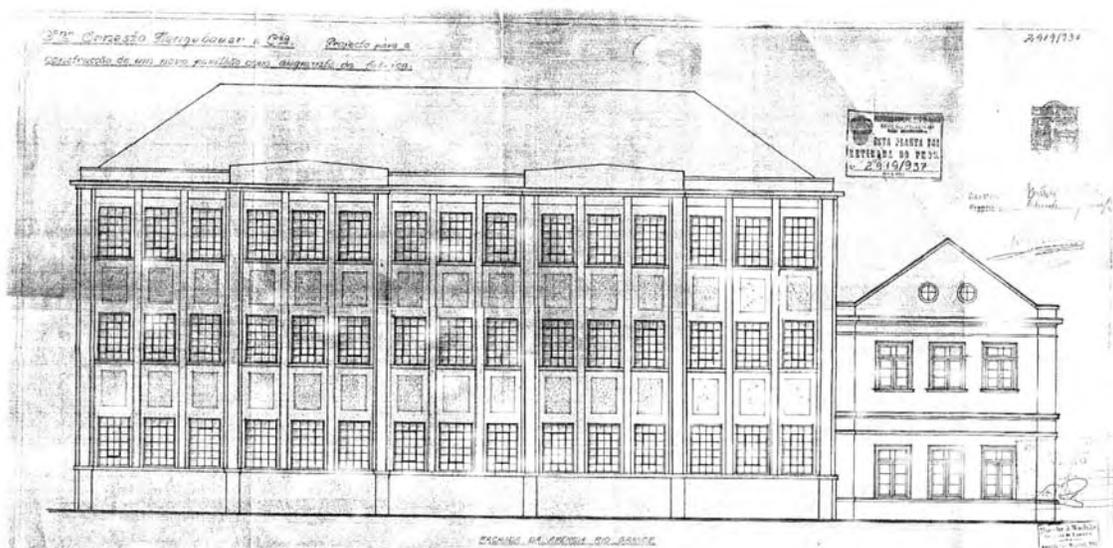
Fachada do edifício da Neugebauer, 1937. Edifício lateral já existente.
